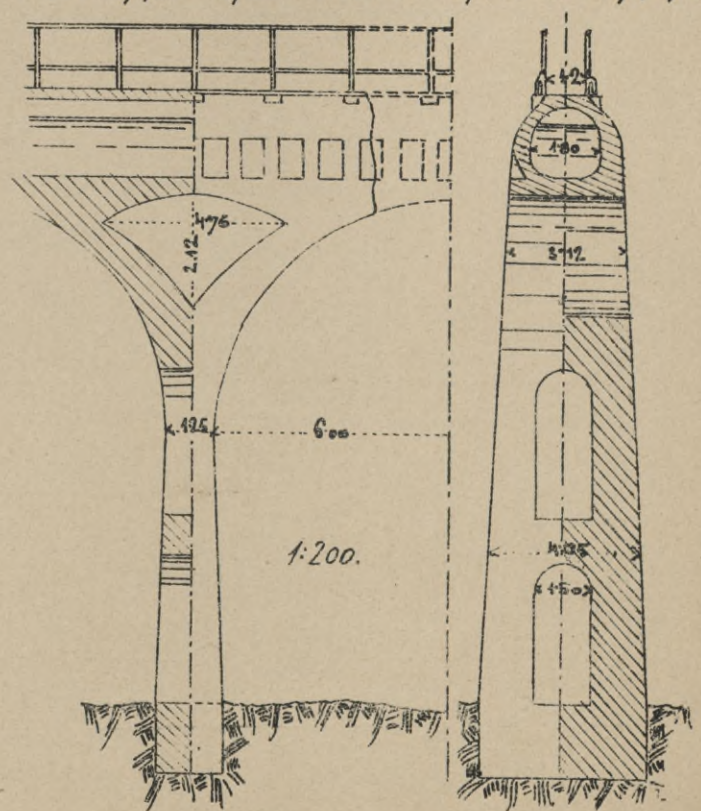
Przekrój podł. Rys. 3b. Widok. Rys. 3c. Przekrój poprzeczny.
